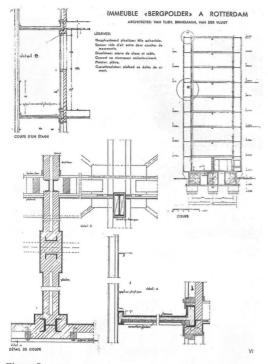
Edificio Bergpolder en Rotterdam. Detalles constructivos (AHCOAM GM/CP016/C1-06)
